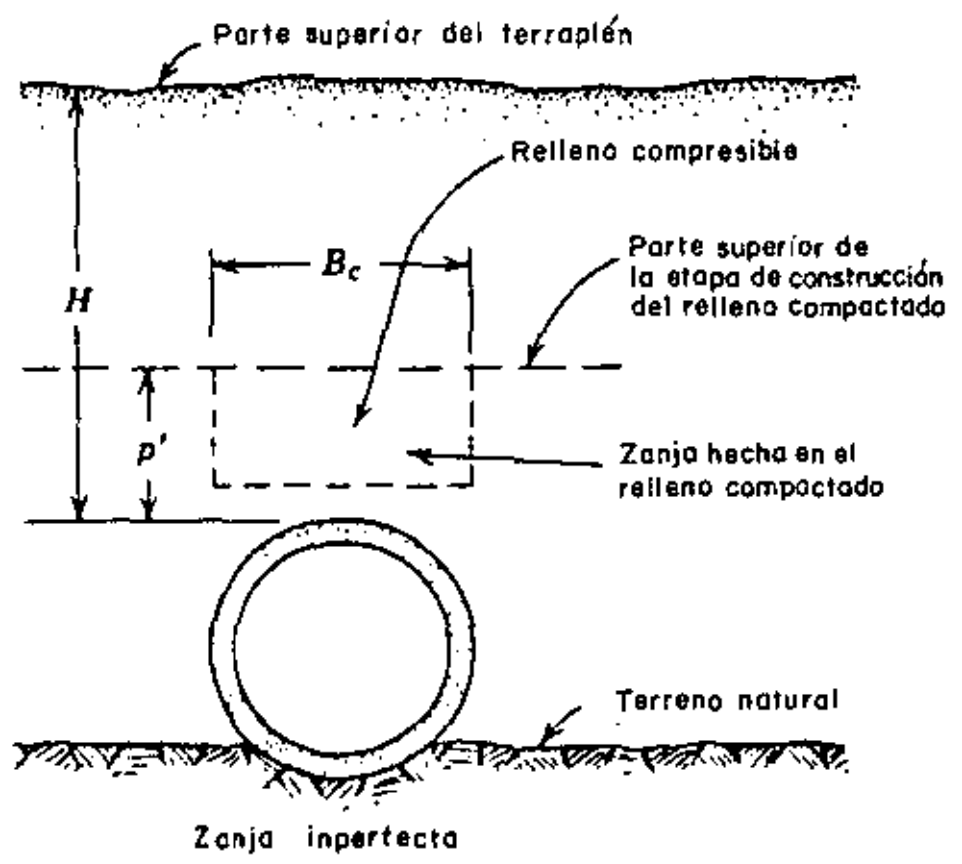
ILUSTRACION DE CONDUCTOS CON ZANJA IMPERFECTA
